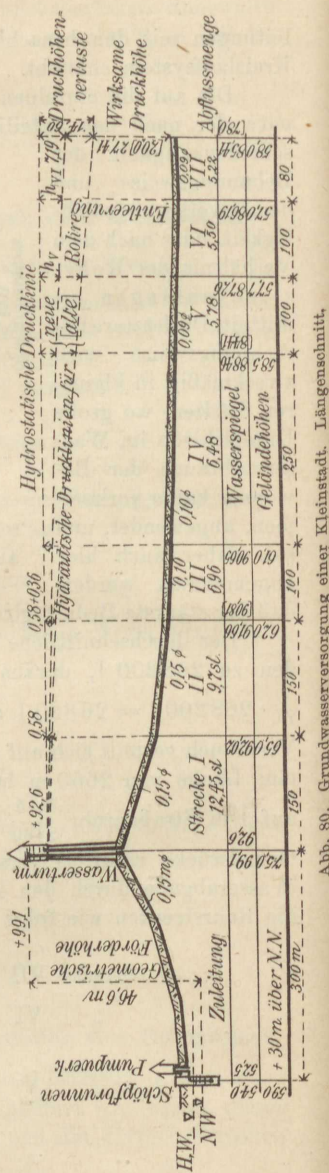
Grundwasserversorgung einer Kleinstadt. Längenschnitt.
